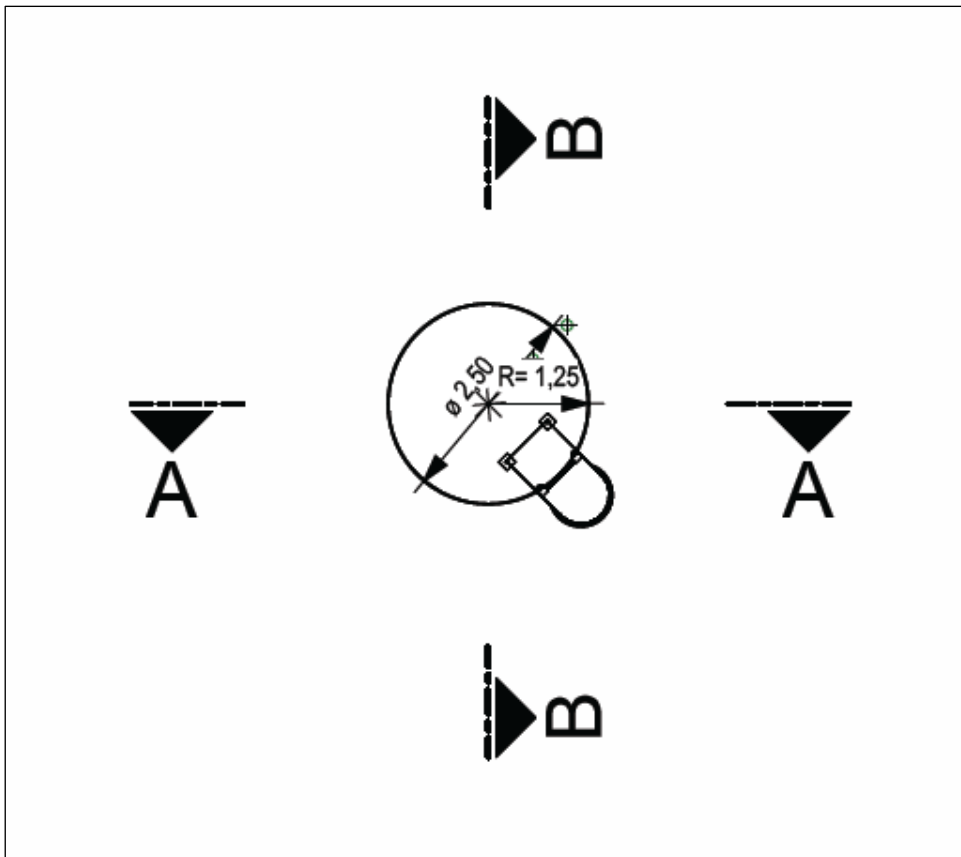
Grundriss EG Vorlagebehälter (o. M.)
